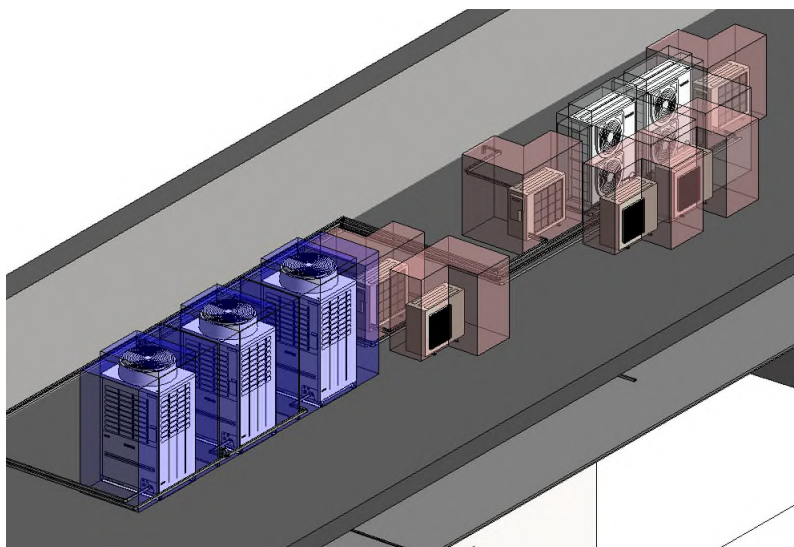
Equipos exteriores terraza ubicada en la tercera planta
